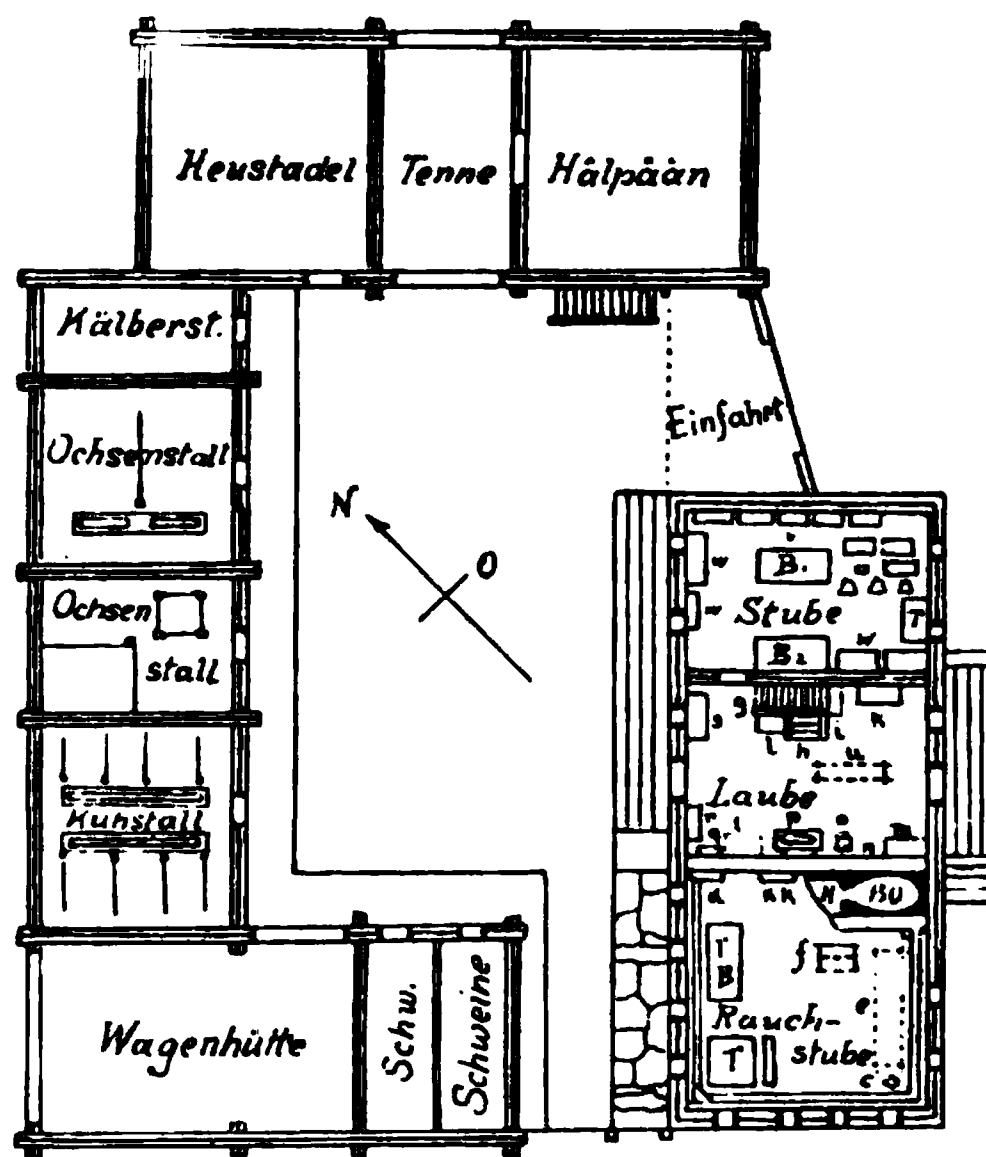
Grundriss vom Hause in Schachen.
